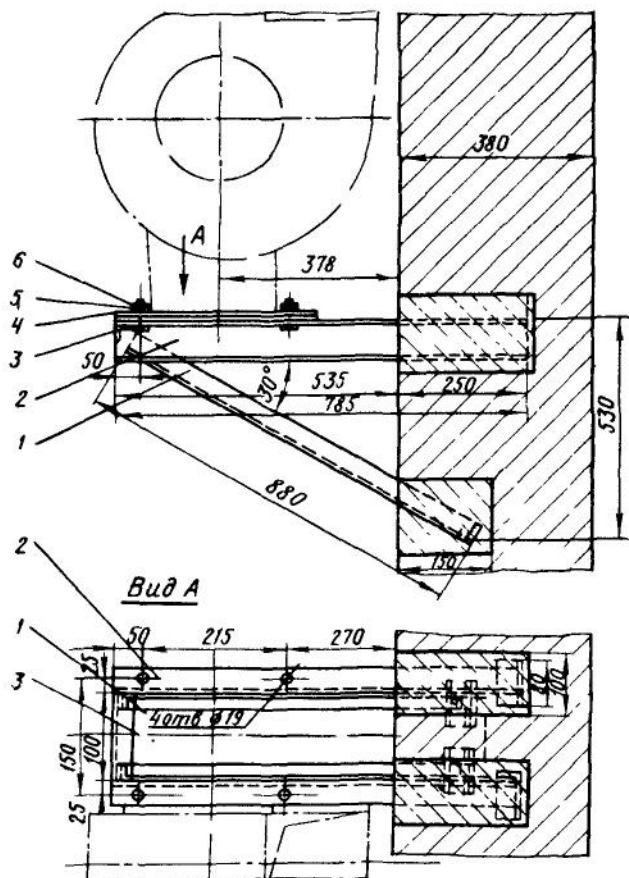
Монтаж радиального вентилятора, устанавливаемого на кронштейнах:
